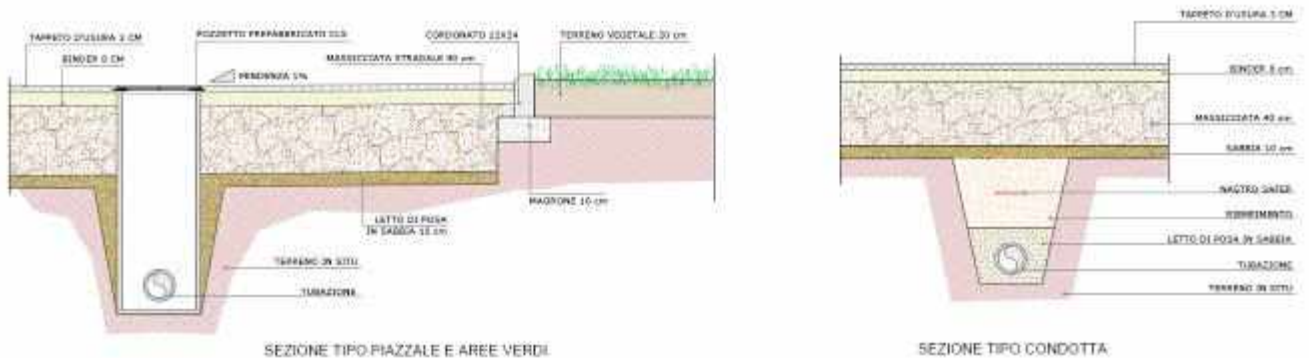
particolare costruttivo pavimentazione piazzali e aree di manovra
